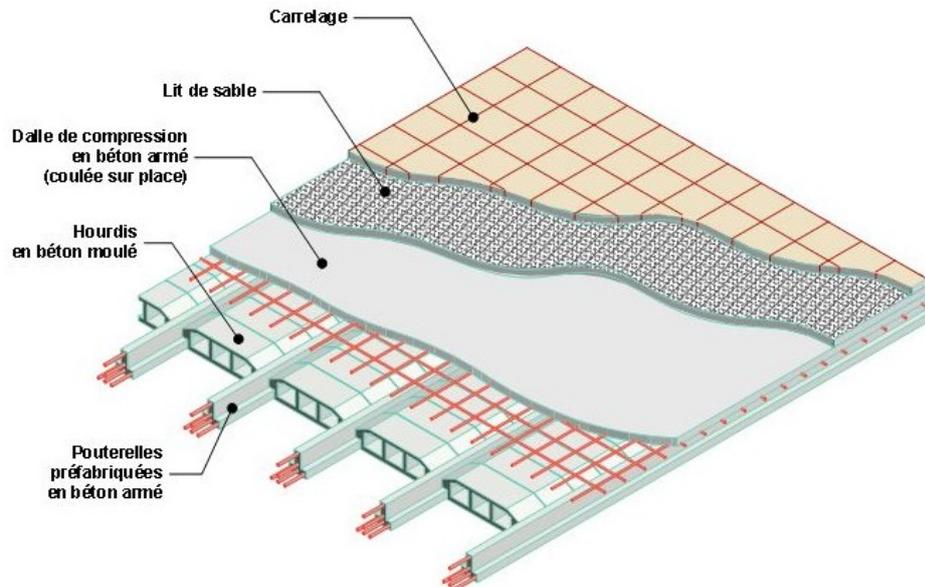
Plancher en béton armé avec poutrelles et hourdis (plancher à corps creux)
